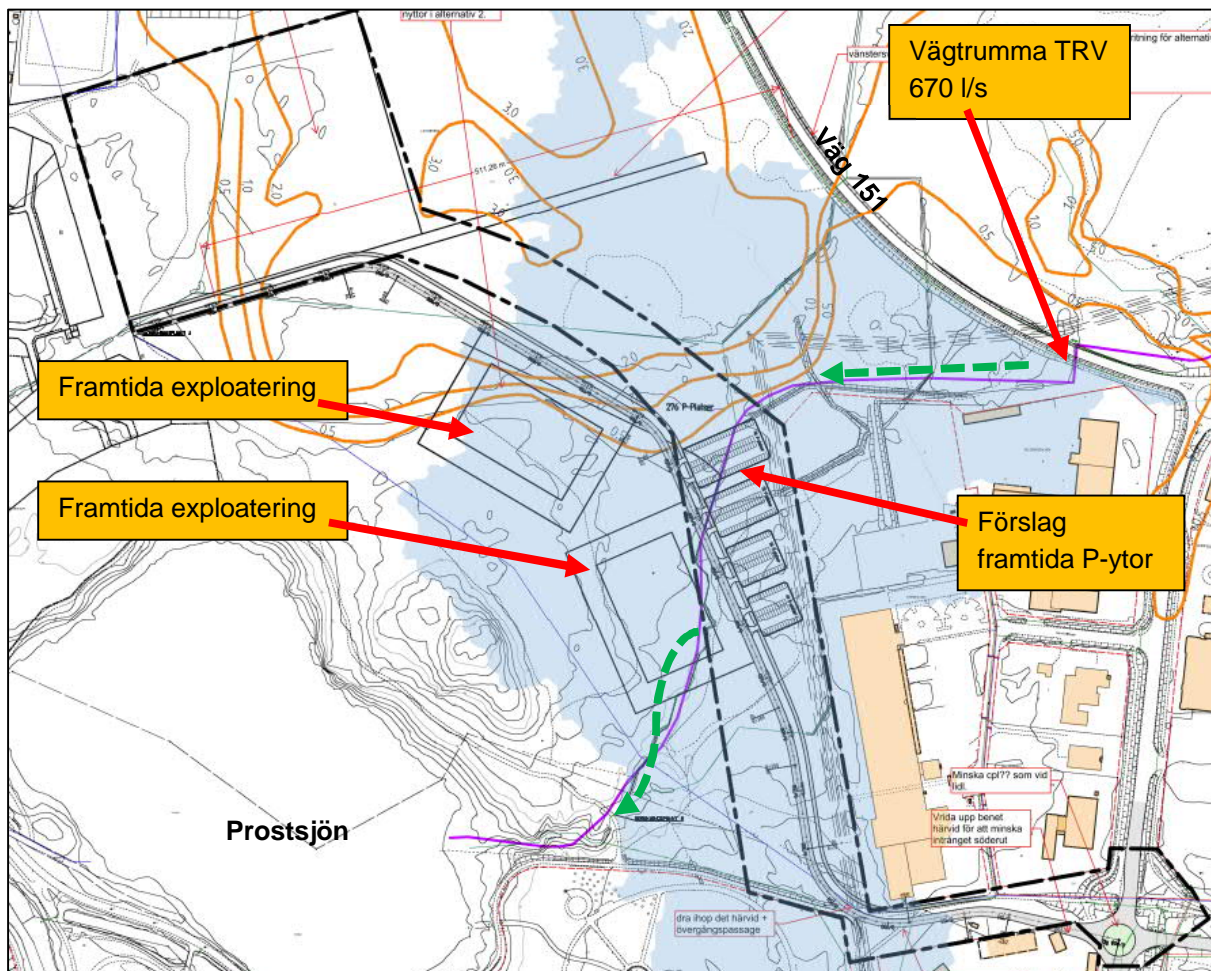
Planerat skyfallsstråk via planområdet se figur 16 för planområdesgränser.
